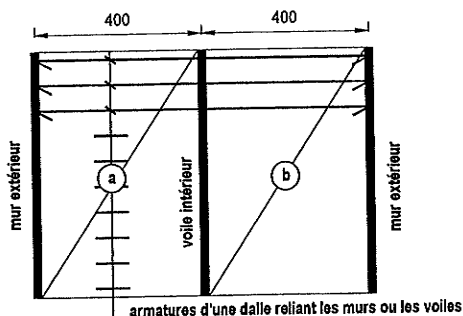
Chaînages multiples dans le plan de la dalle.
